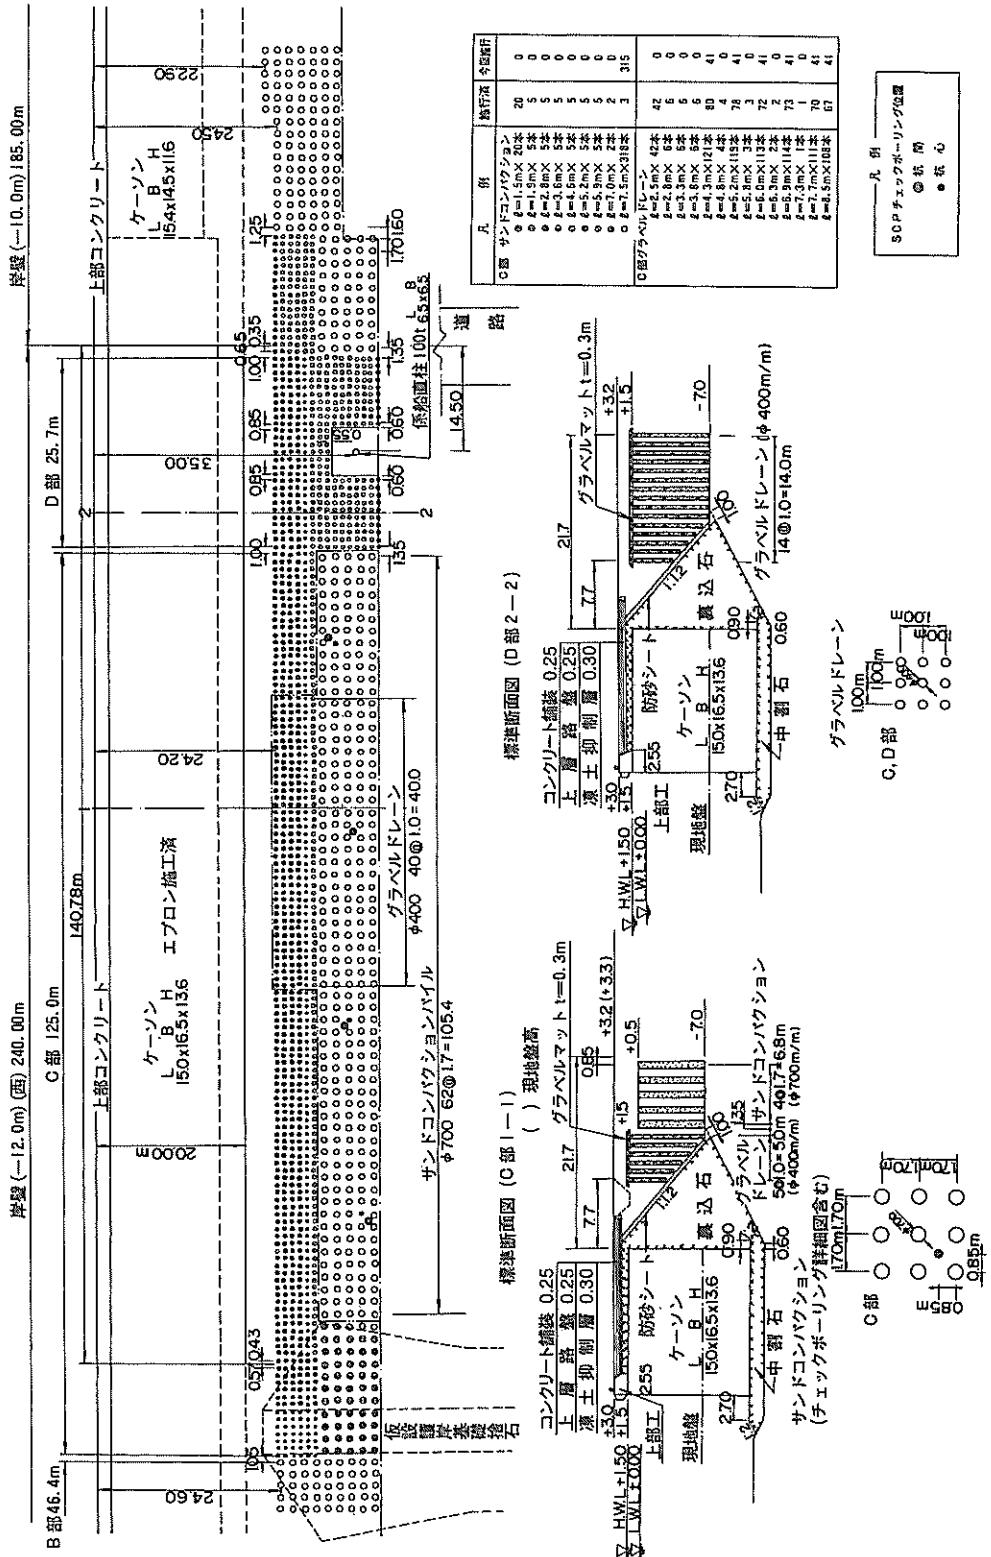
液状化対策平面図・断面図（第三埠頭地区、⑥西側岸壁（-12.0m））
